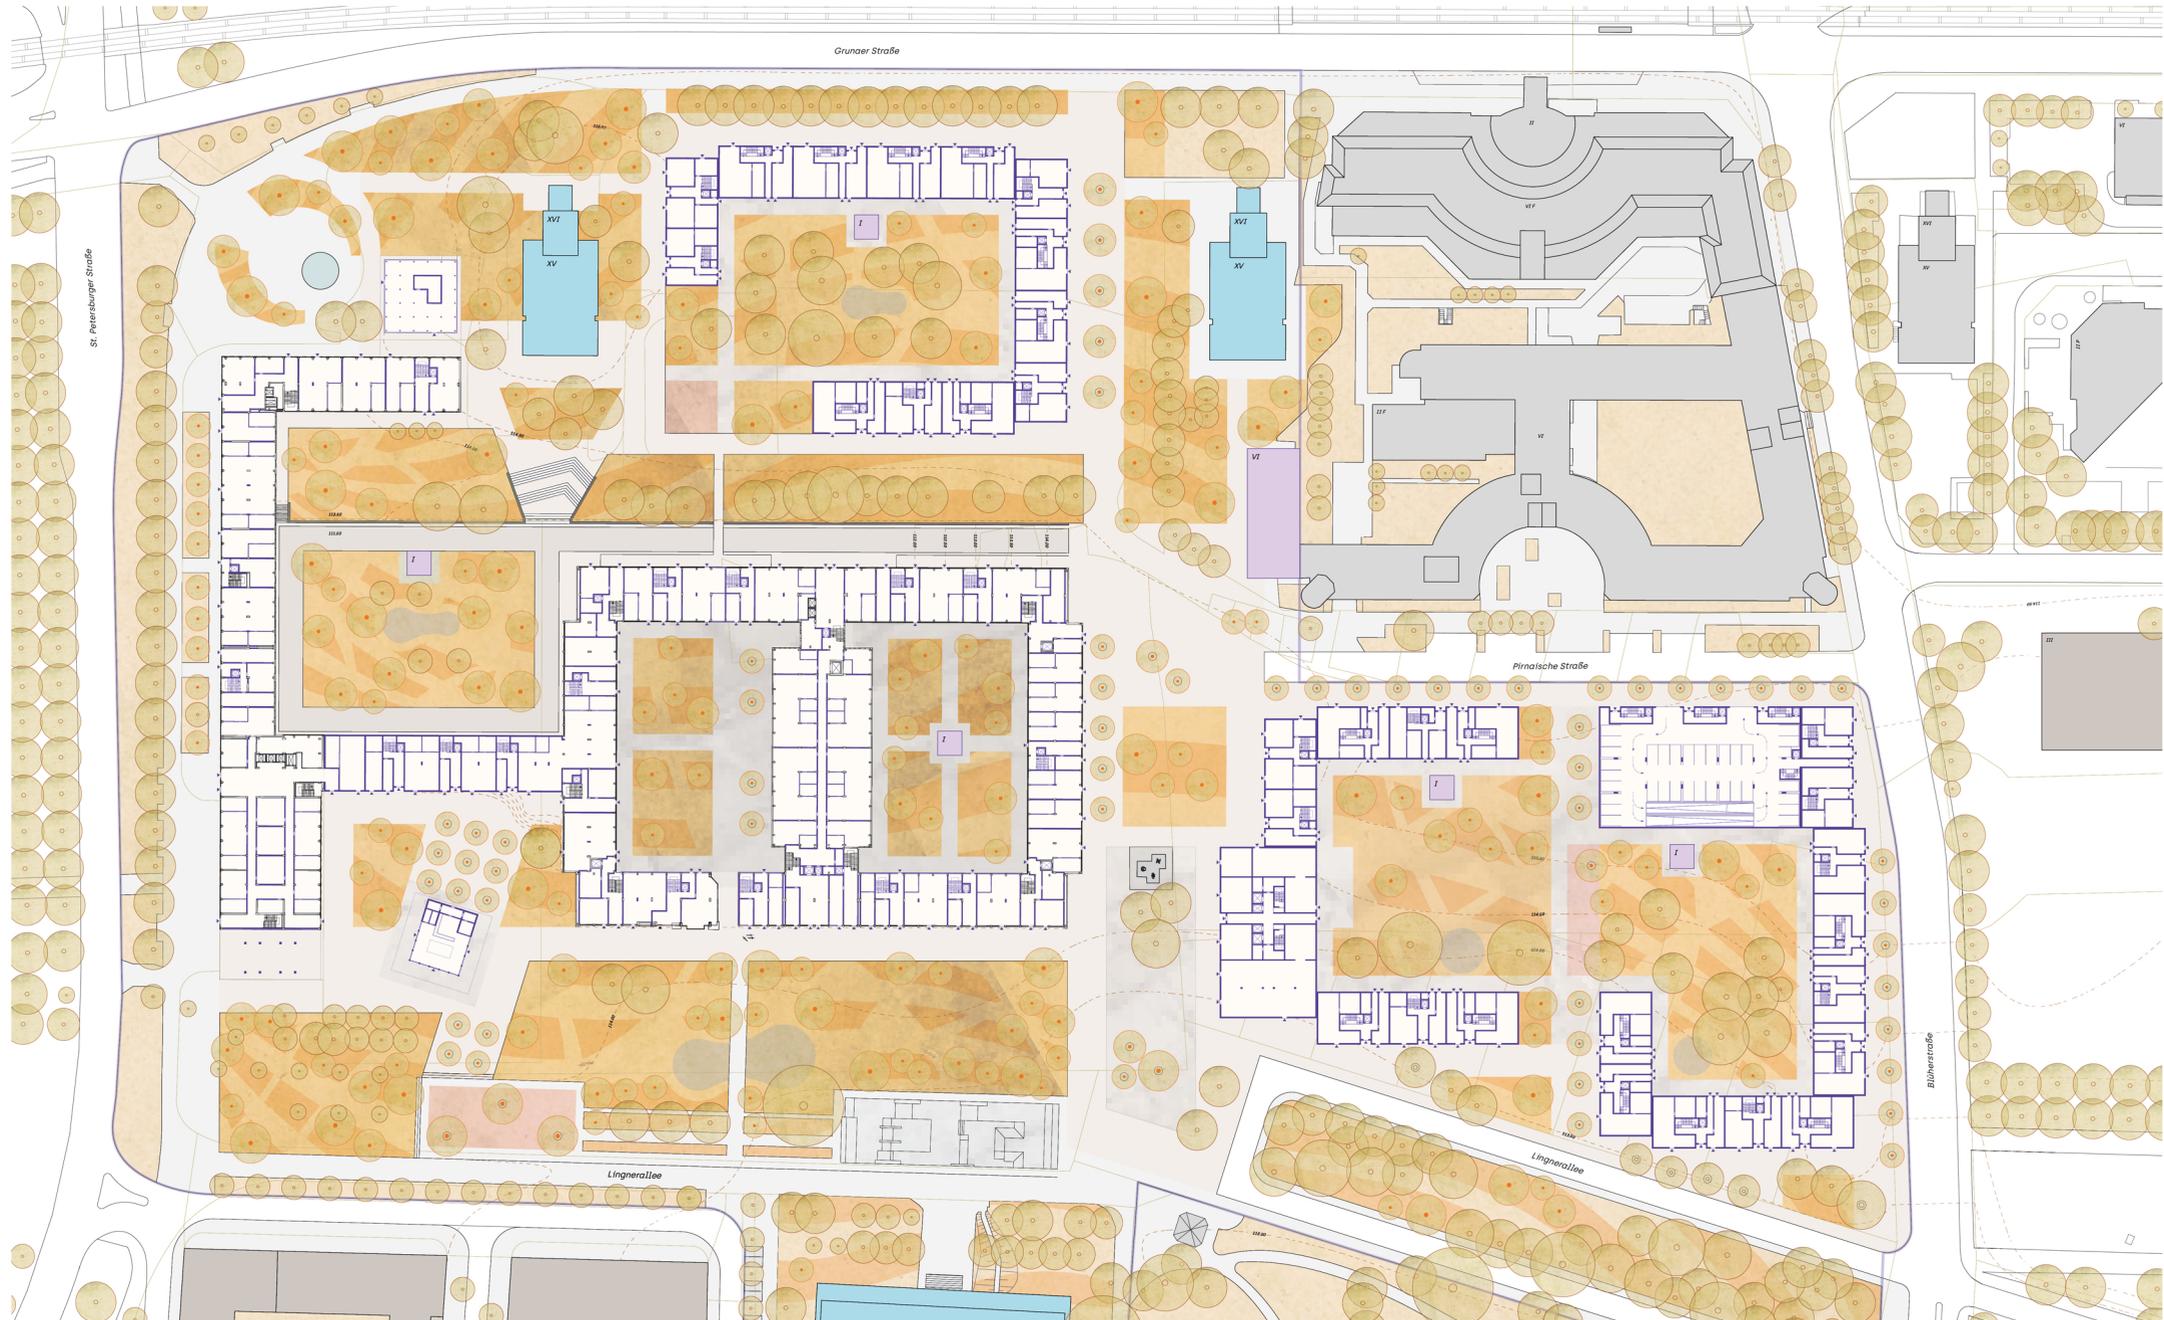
Lageplan mit Erdgeschossgrundriss Eigene Darstellung auf Basis von Geodaten (© Stadtplanungsamt, Amt für Geodaten und Kataster, Landeshauptstadt Dresden), Zeichnung: Paul Breitenfeldt und Reto Lucek. Alle Rechte vorbehalten
